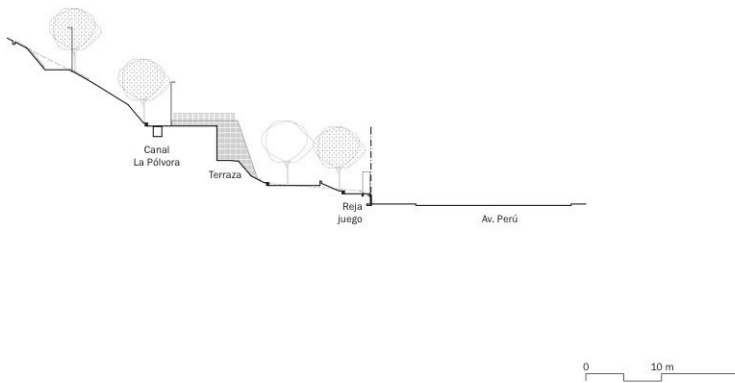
C Corte transversal B. Fuente: Arch Daily
